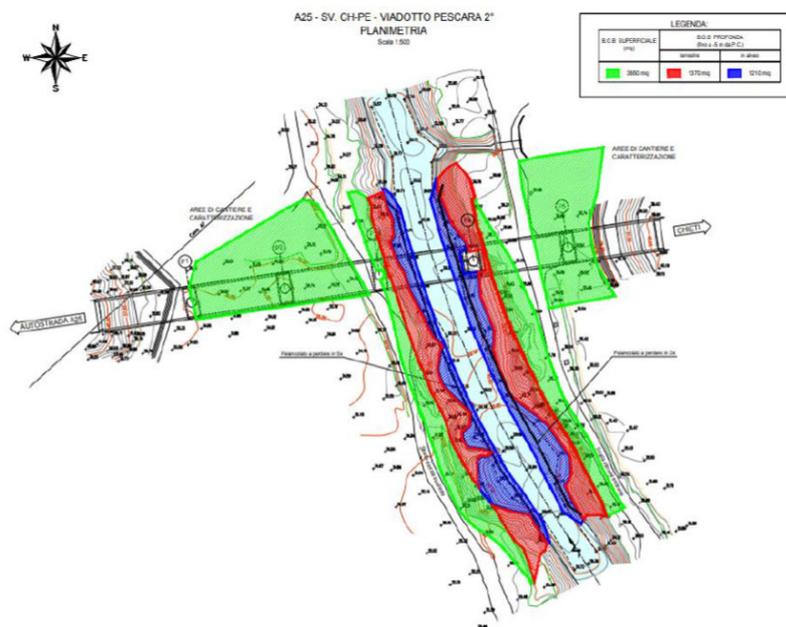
Planimetria delle aree interessate dalle diverse tipologie di bonifica da ordigni bellici²⁷
